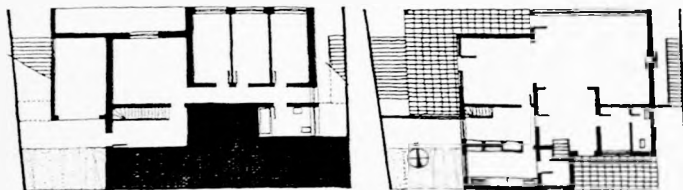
e 396 Planta subsolo e térreo casa da rua Bahia.
